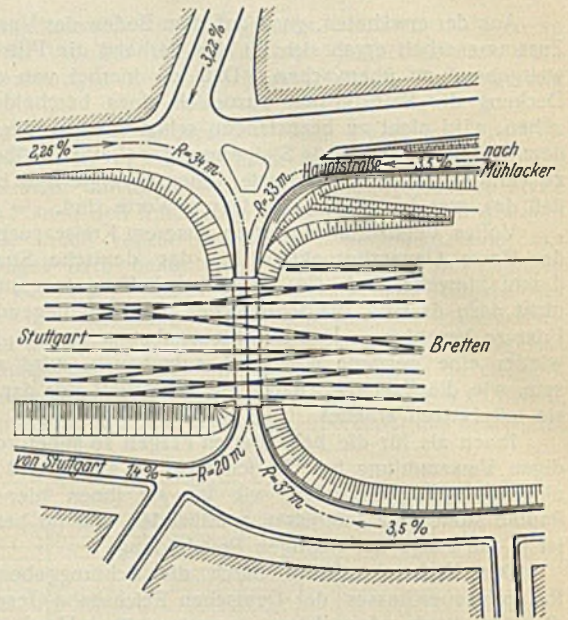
Unterführung der Staatsstraße Stuttgart—Mühlacker unter den Eisenbahngleisen bei Zuffenhausen.
